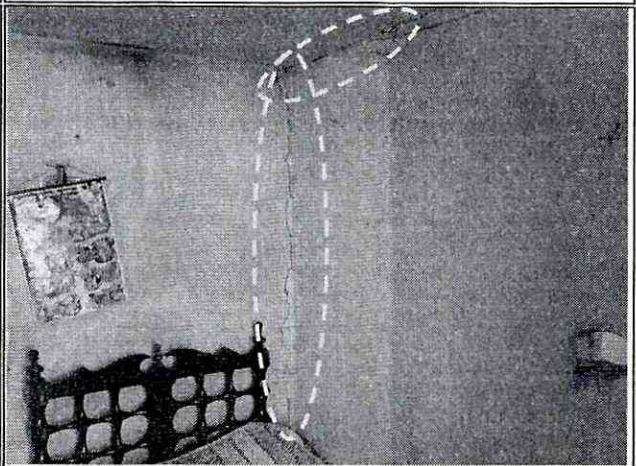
Se aprecian grietas longitudinales en los vértices de los muros internos de la vivienda evaluada.
